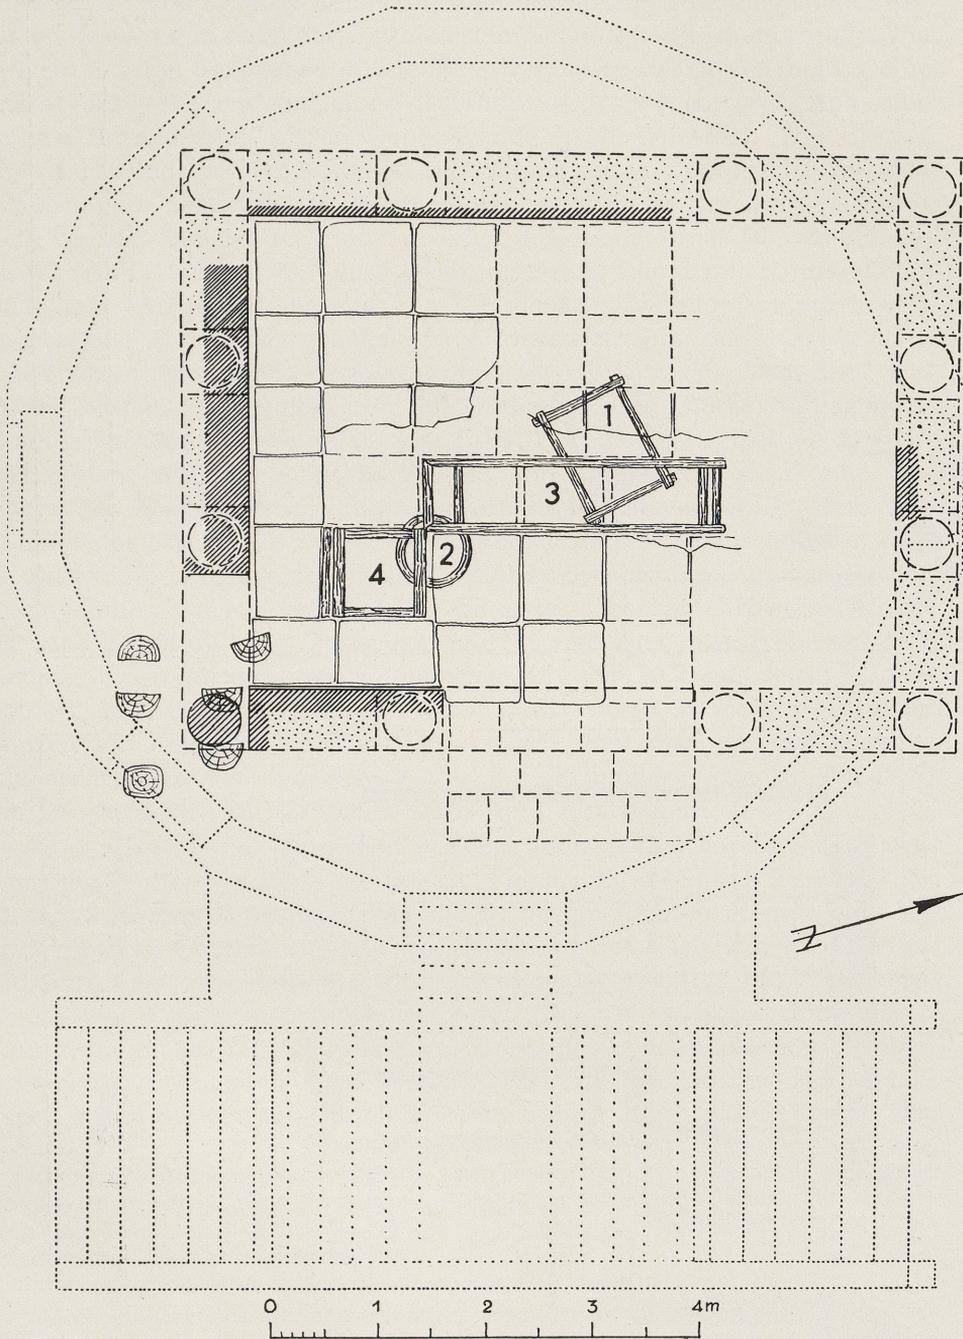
Trier, „Römersprudel“. Gesamtgrundriß des modernen vieleckigen und des römischen rechteckigen Brunnenhauses mit den Quellfassungen 1-4
